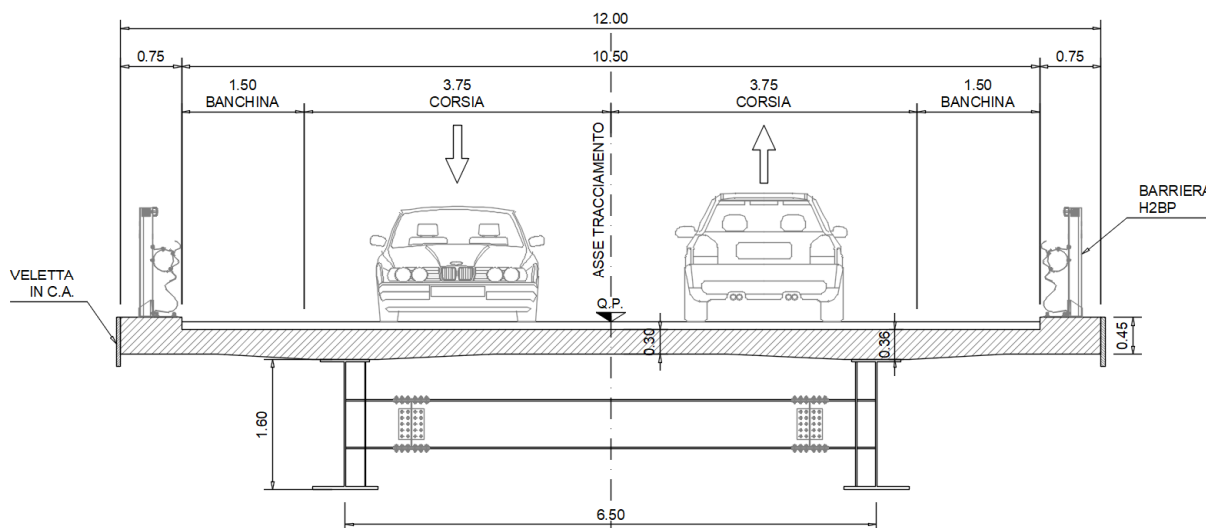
Mezzanelle – Sezione tipo impalcato
